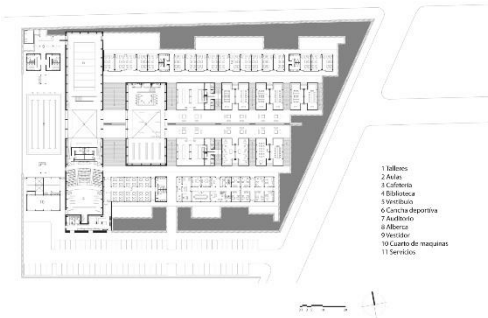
planimetría, centro de invidentes y débiles visuales. Fuente: Archdaily
